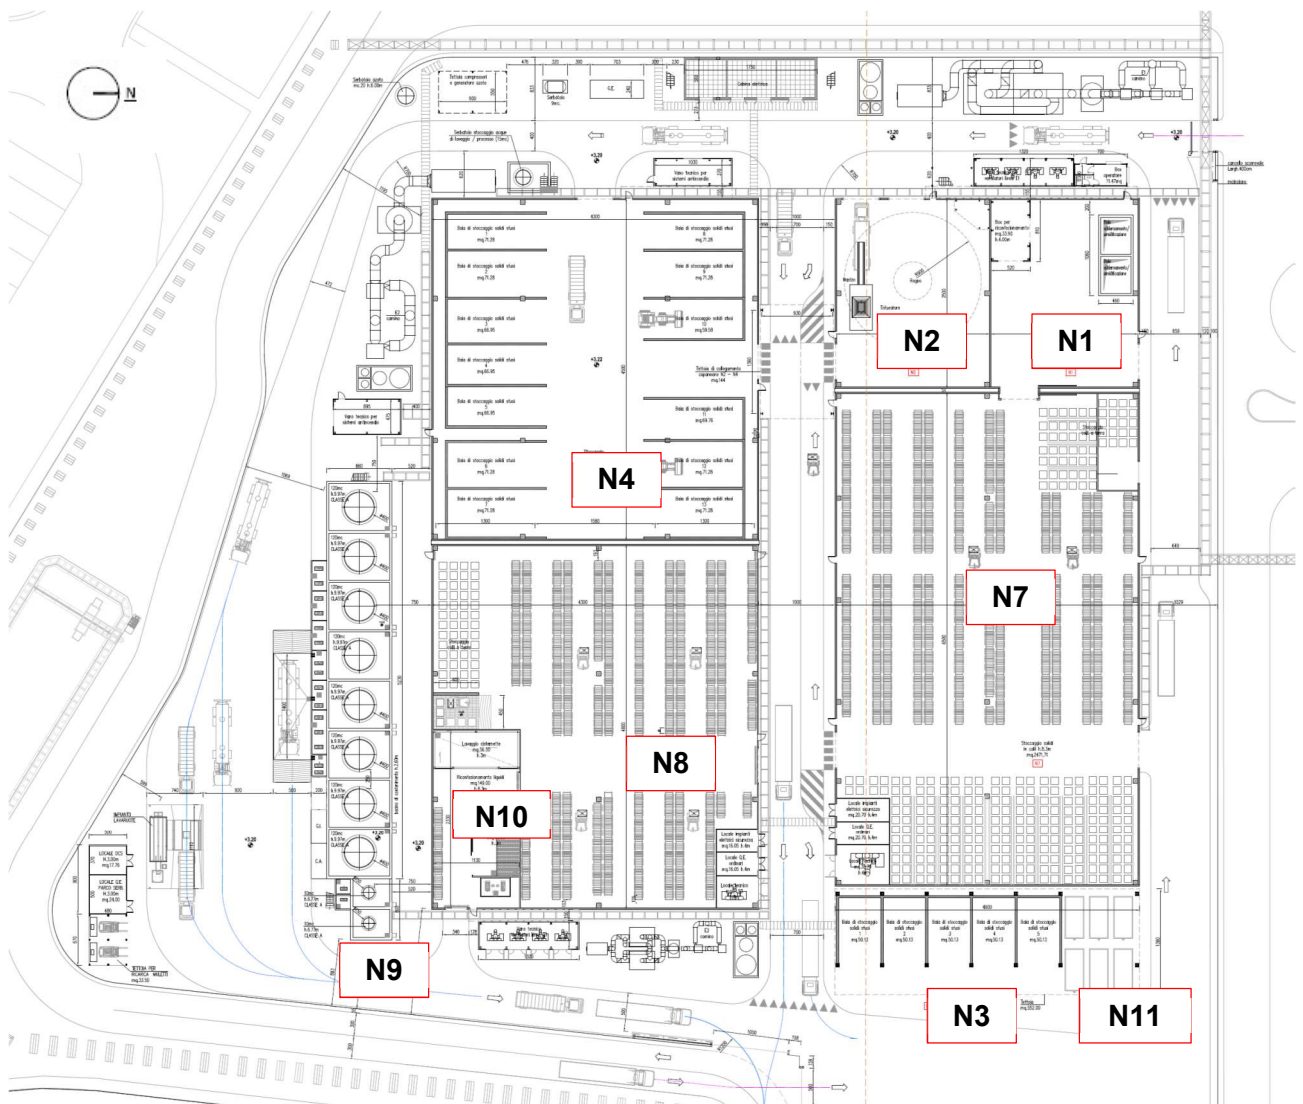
Stralcio della planimetria layout generale piattaforma (cod.doc. CO 05 RA VA 00 D1 PL 35.00 - LAYOUT GENERALE PIATTAFORMA). Dettaglio sezioni in progetto.
